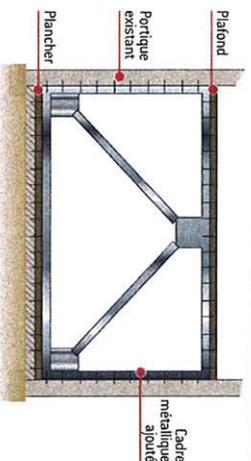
Exemple de renforcement du contreventement par ajout de croix type K ou similitudés en charpente métallique ou en poutre de béton armé à un panache existant (coupe transversale)
